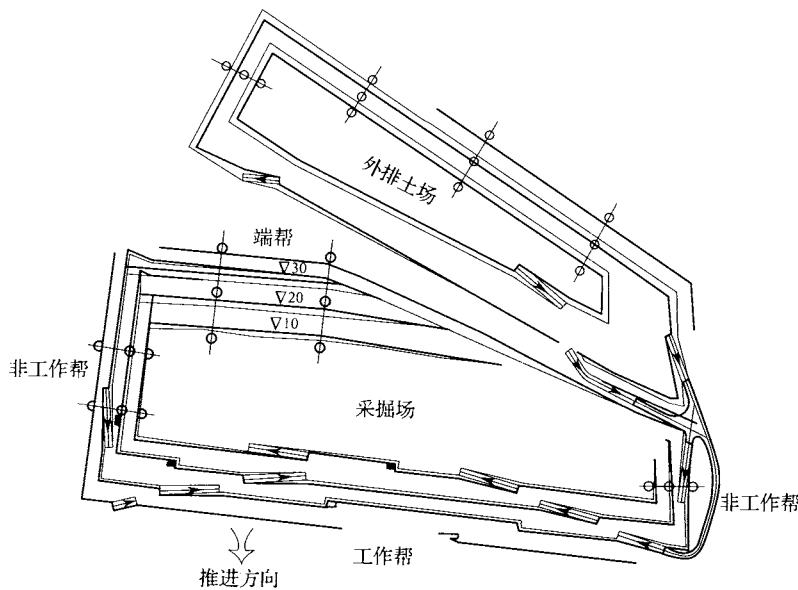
1 露天煤矿边坡工程监测点布置示意图
